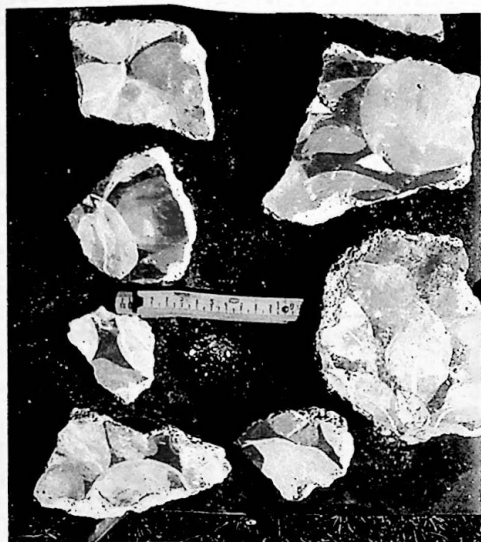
Frammenti di soffitto dalla casa dell'ex Beneficio Parrocchiale.
